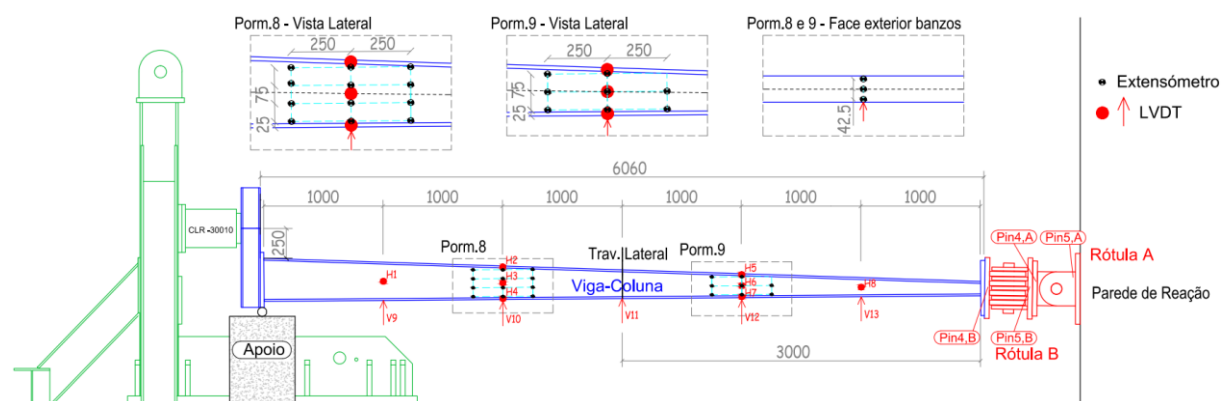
Configuração geométrica de ensaio da Viga-coluna.
